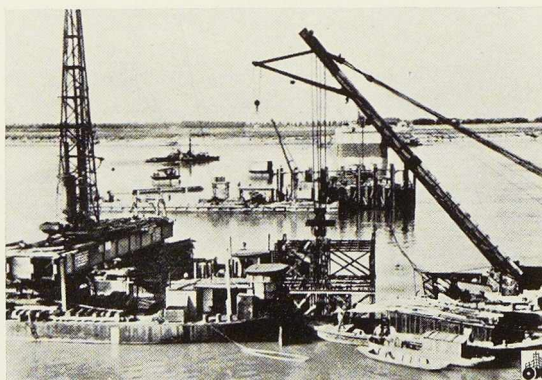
Travaux de construction des piles en maçonnerie du pont sur le Danube près de Belgrade.
